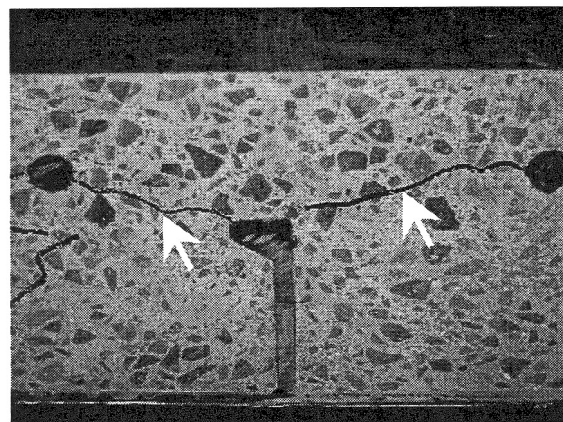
水平ひび割れ発生状況 (Hit1 試験体)
